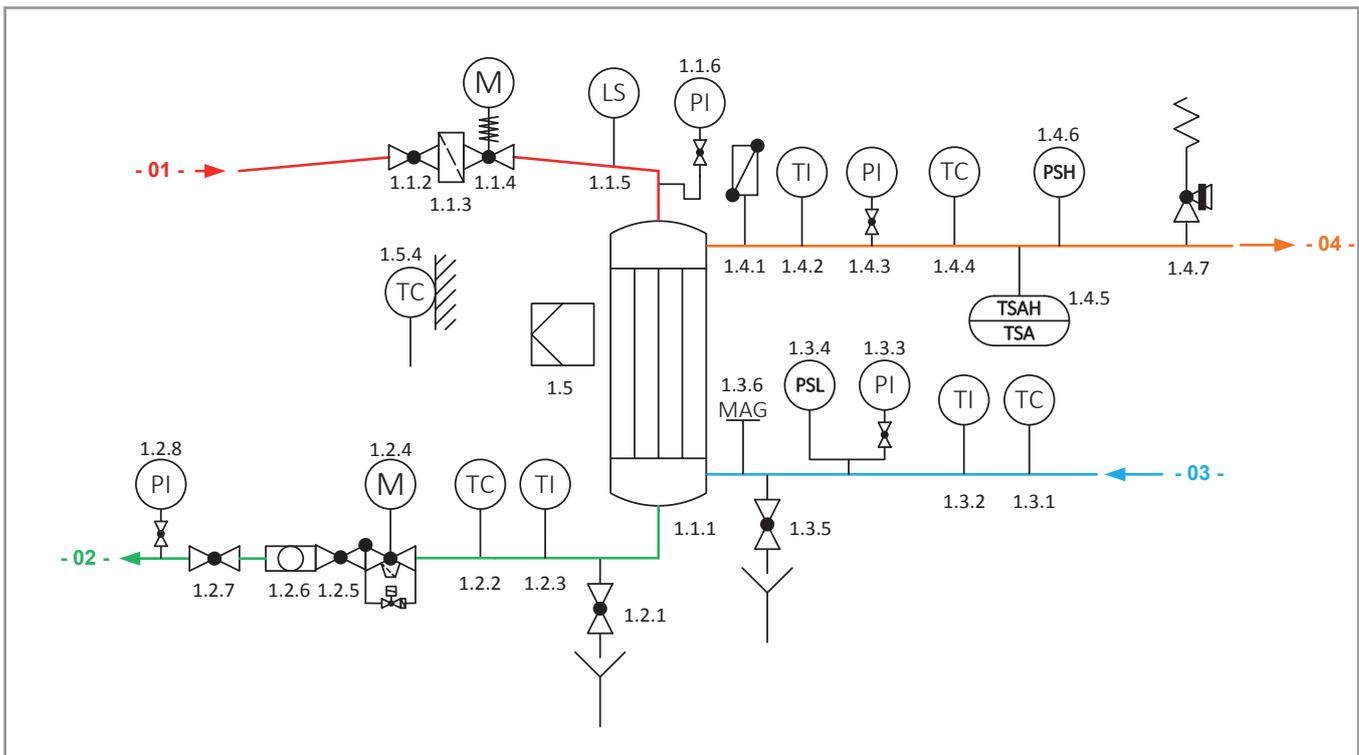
Exemple de schéma d'installation : 150 kW - 200 kW (≥ 3 bar)
